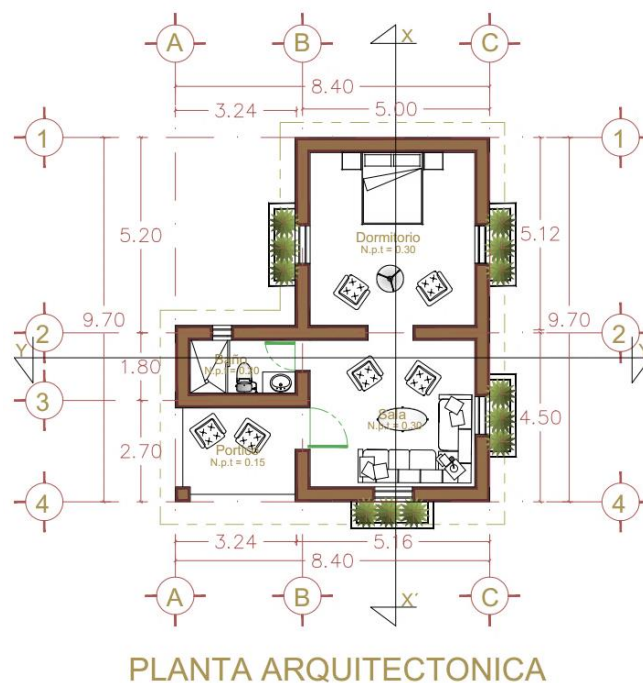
Planta arquitectónica de las cabañas a construir (Ver apartado VIII. 1. 1).
